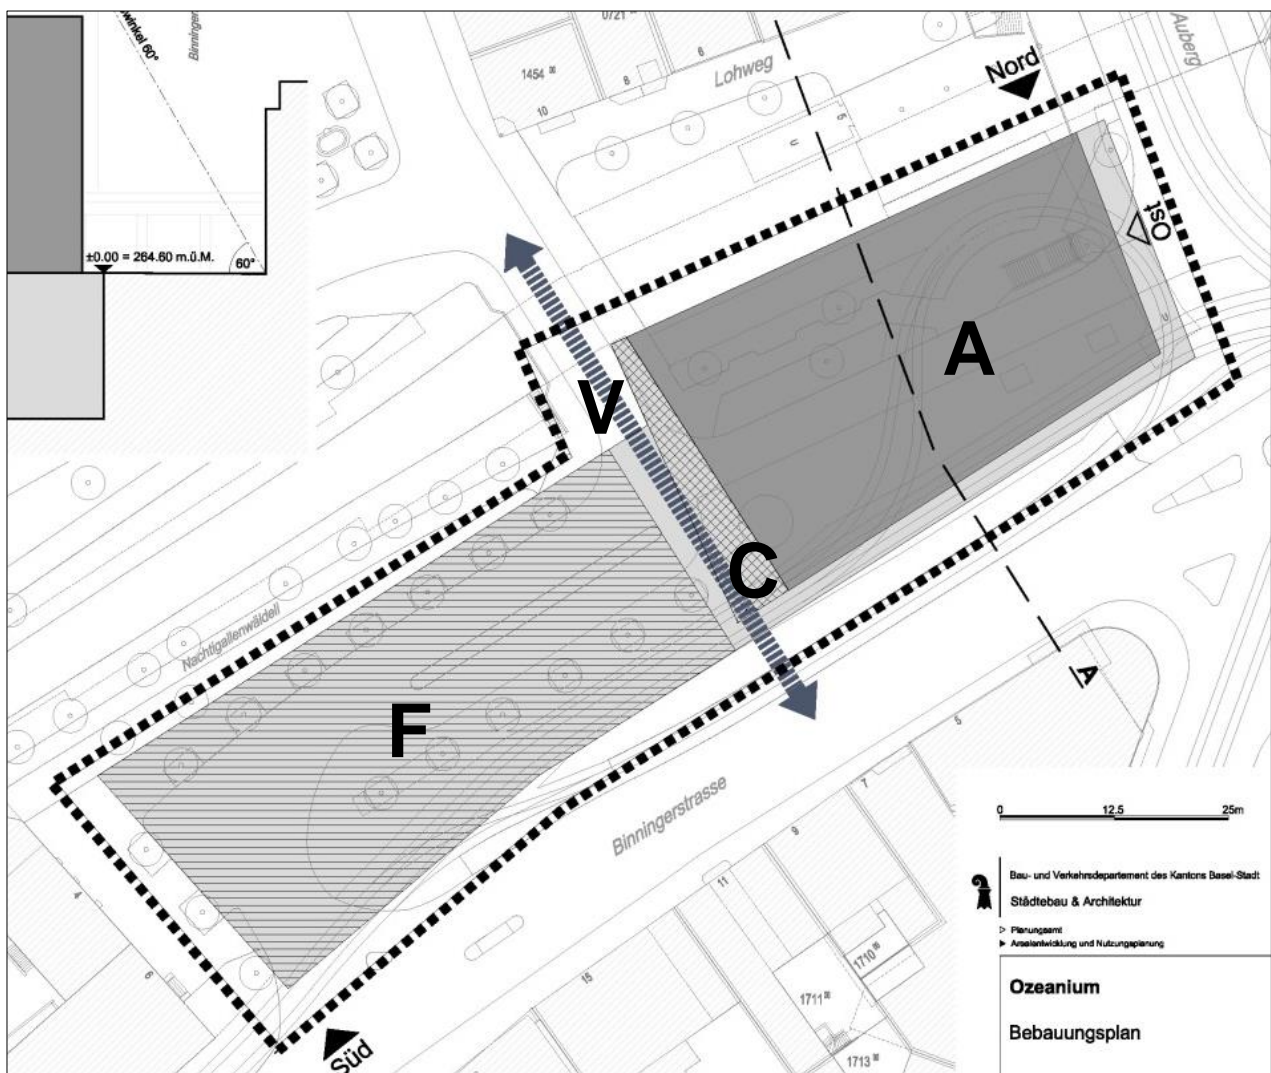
Neuer Bebauungsplan Plan Nr. 13'912 (Kein Massstab, Plan genordet)
